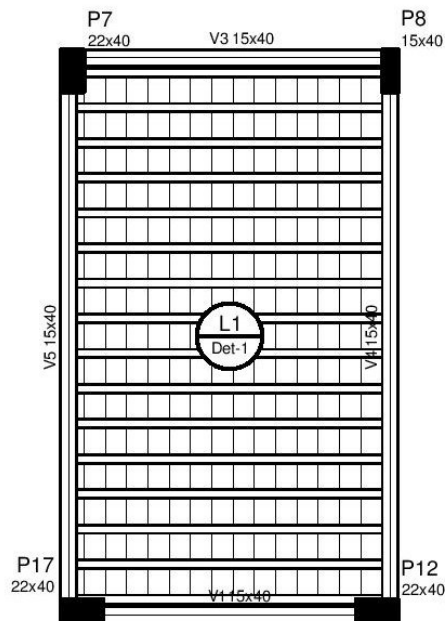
Planta de formas do projeto estrutural: Barrilete
